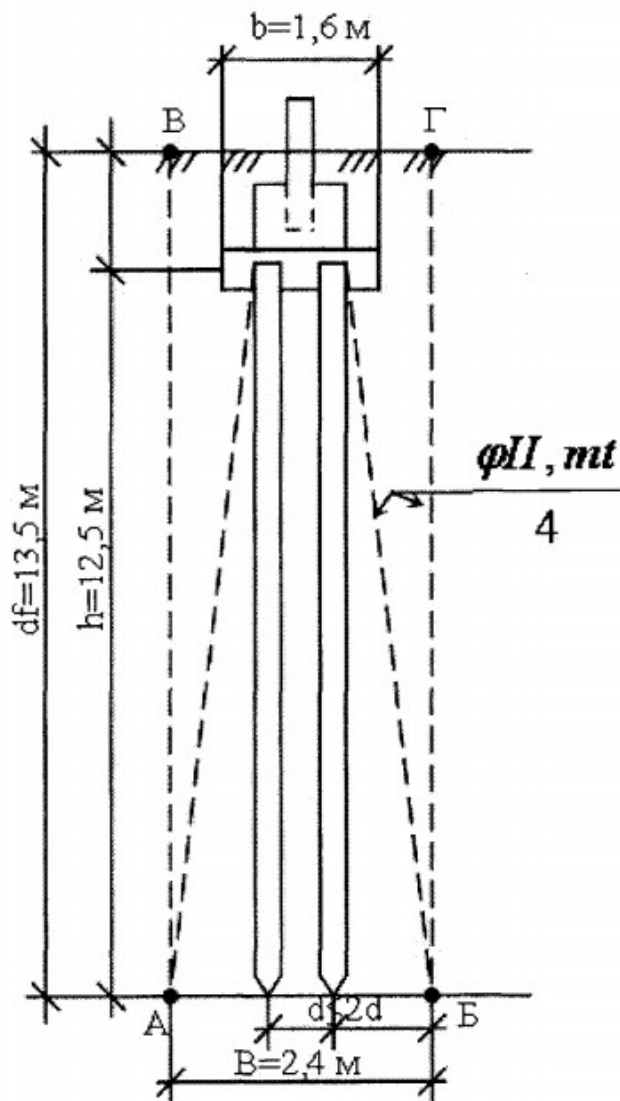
Визначення меж умовного фундаменту при розрахунку осадок пильових фундаментів
